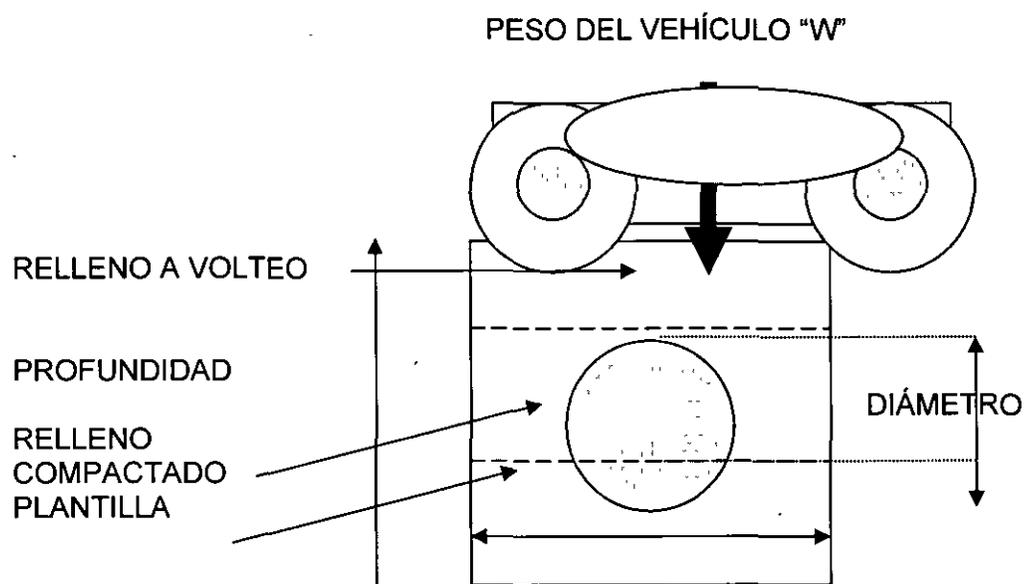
CARACTERÍSTICAS DE LAS ZANJAS
